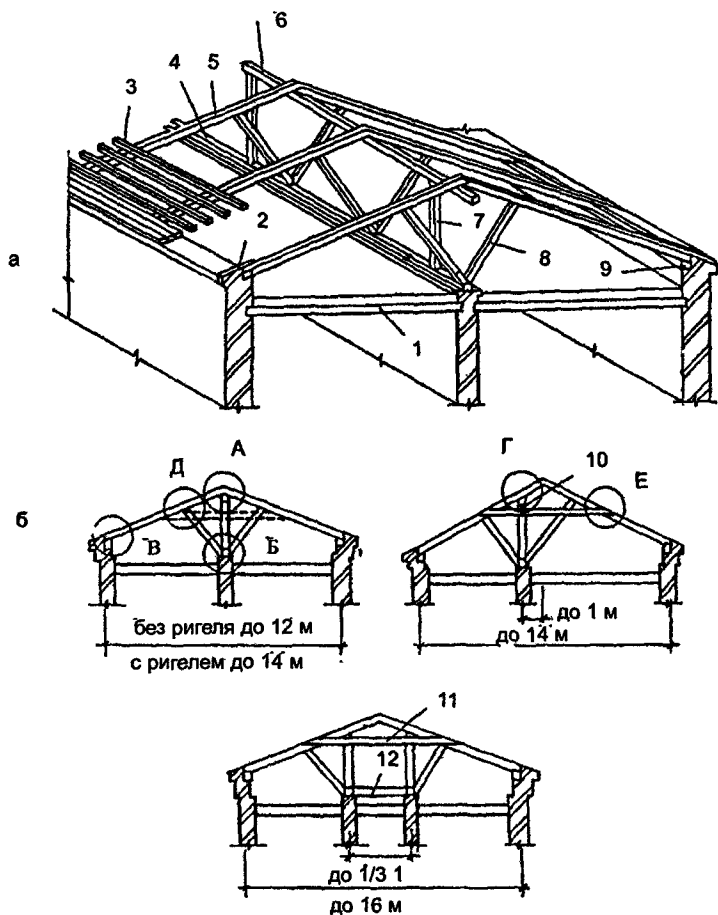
Конструктивные схемы деревянных наклонных стропил:
